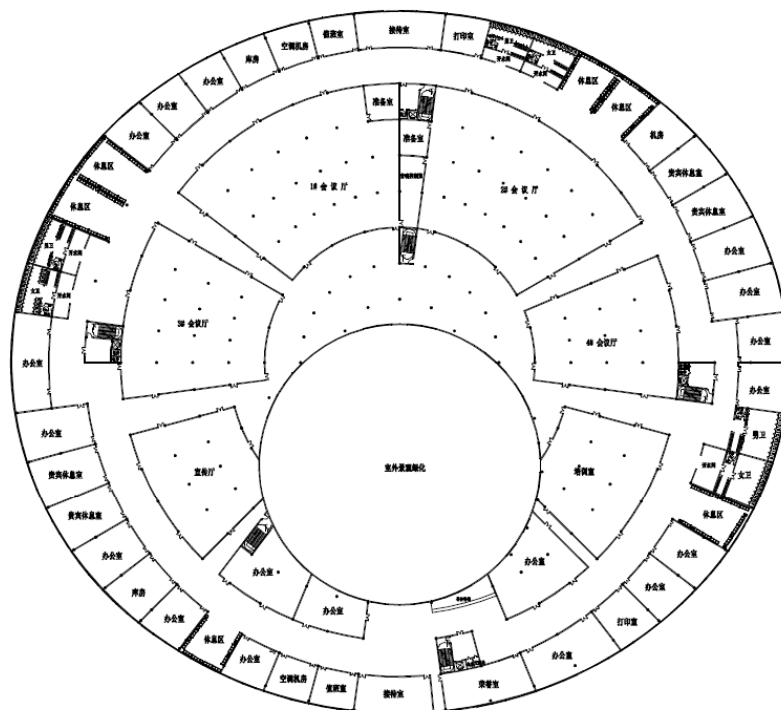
海洋生态科技馆平面布置图（一层）
